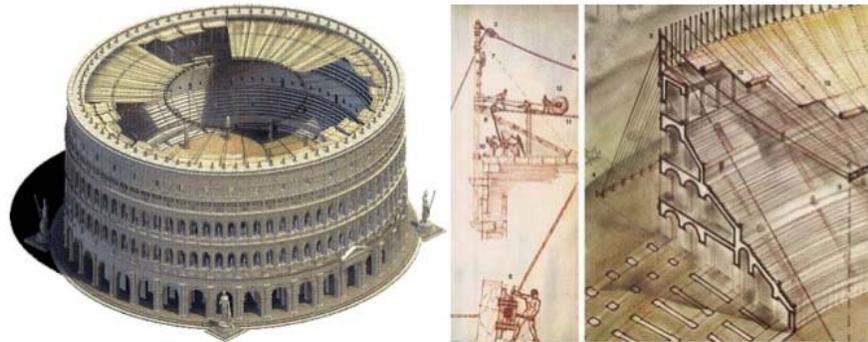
Coliseo Romano, Construido en el Siglo I d.C. Perspectiva y Detalle estructura "velaría" de Cubierta.
